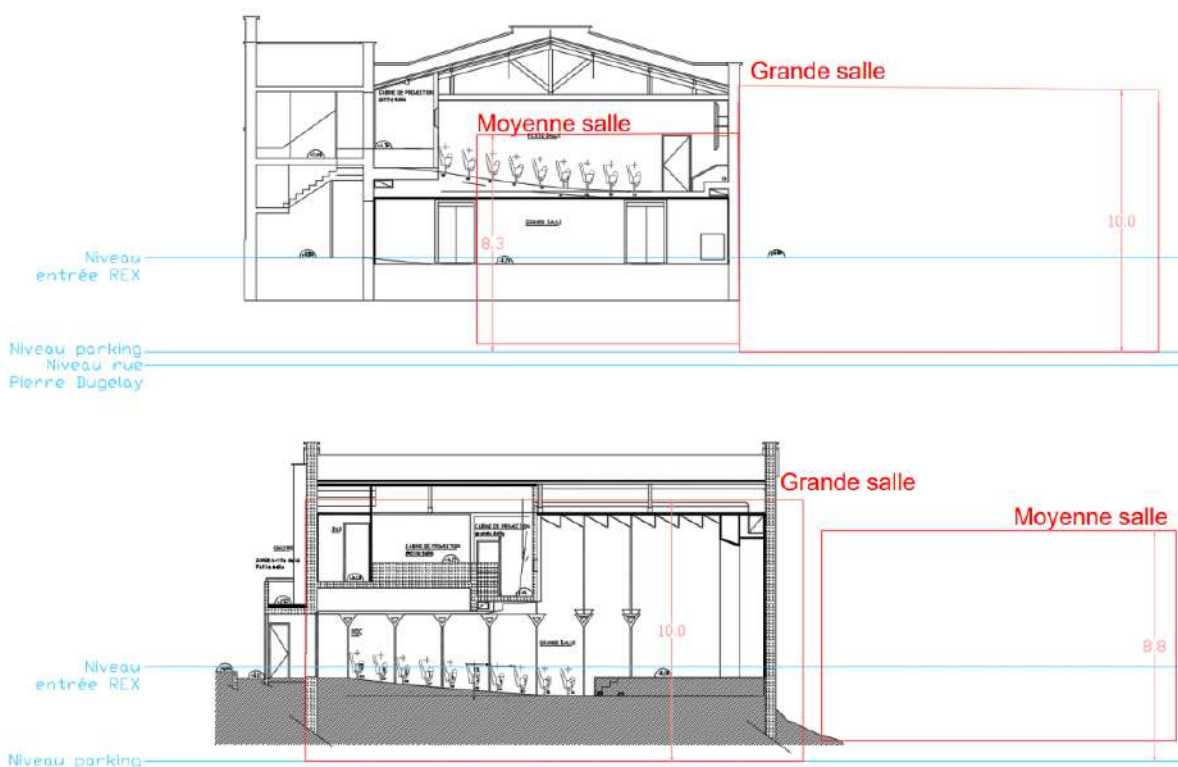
Coupe et plan d'élévation des salles, scénario n° 2
